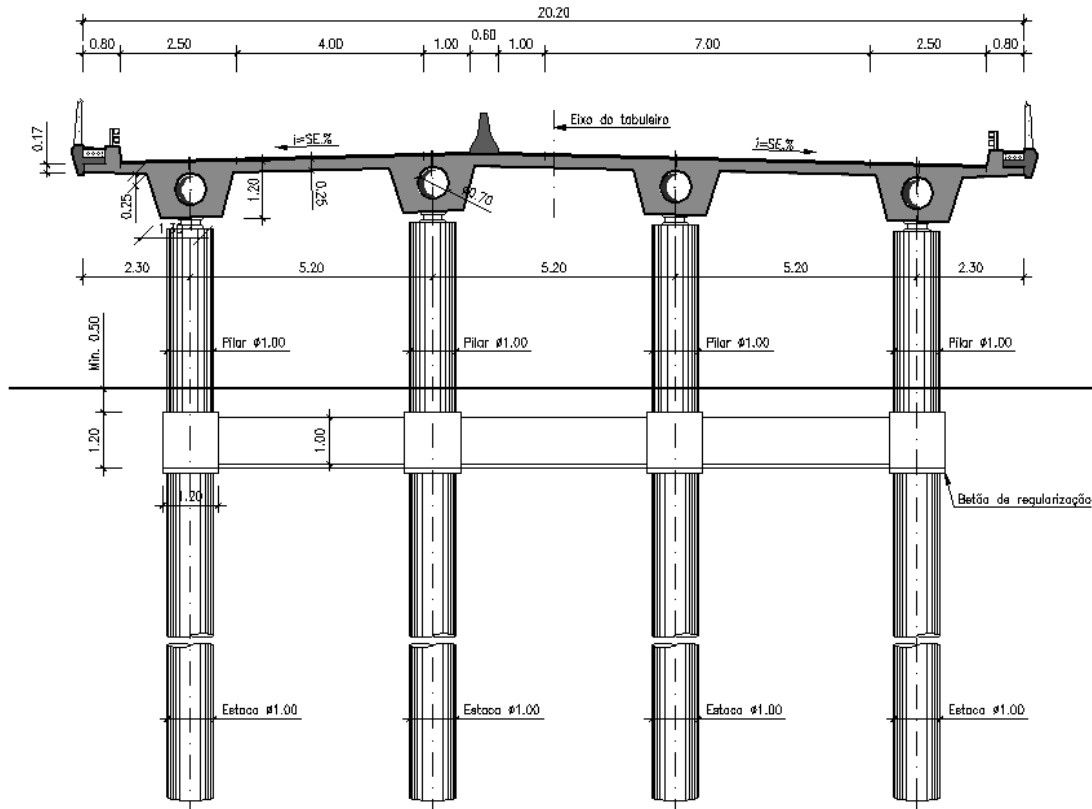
Secção transversal tipo do viaduto sobre o Rio da Moita - Solução 2 (secção corrente).
